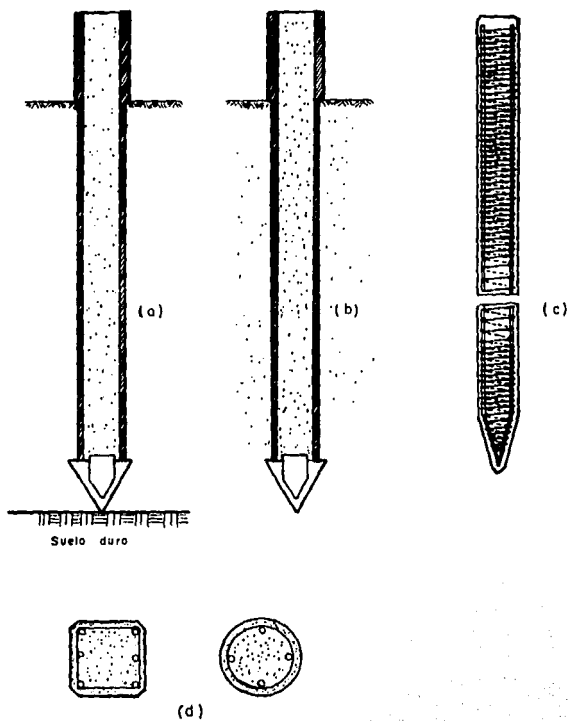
Cimentación con pilotes. a) Pilotes de punta, b) Pilotes de fricción. c) Armado de pilotes de concreto, d) Secciones tipo de pilotes de concreto.
